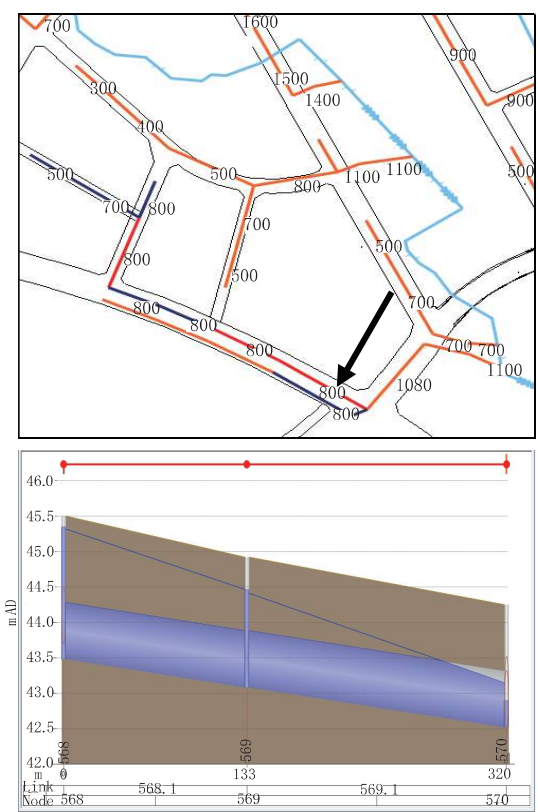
梅溪路与宝成路交口管道平面位置及纵断面图
